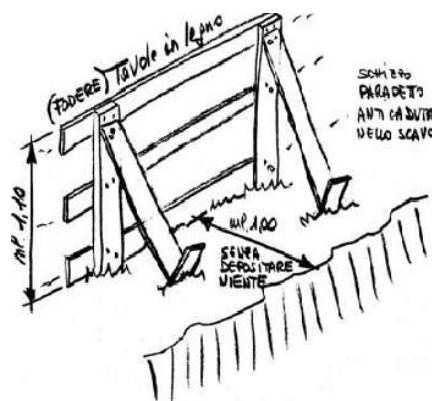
schema di parapetto tradizionale in legno da installare sul bordo degli scavi
